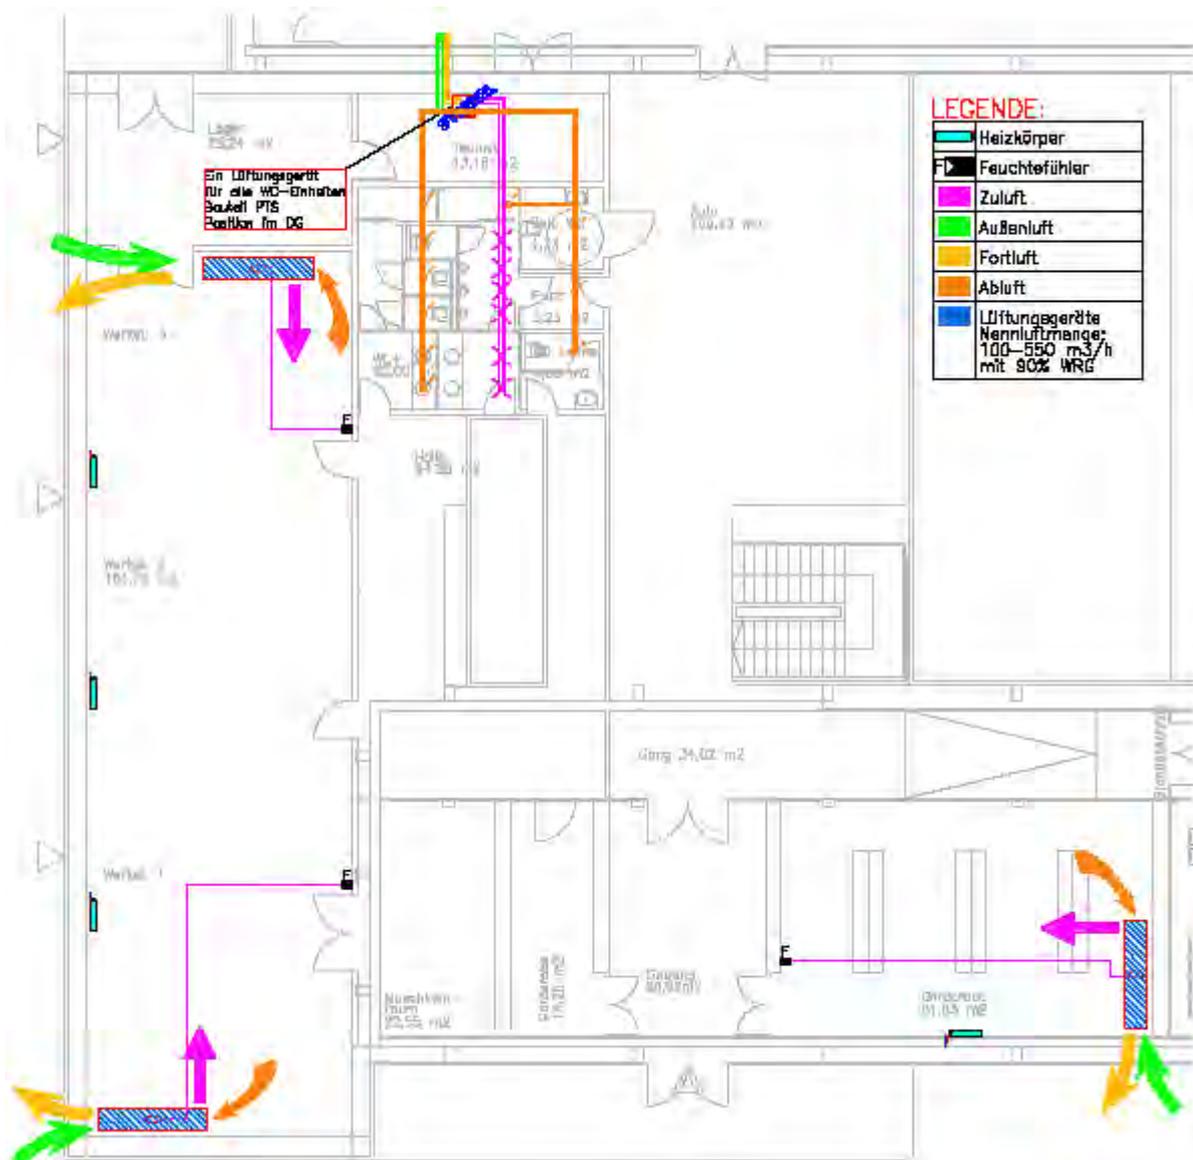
Prinzipdarstellung dezentrale Lüftung Grundriss PTS EG
